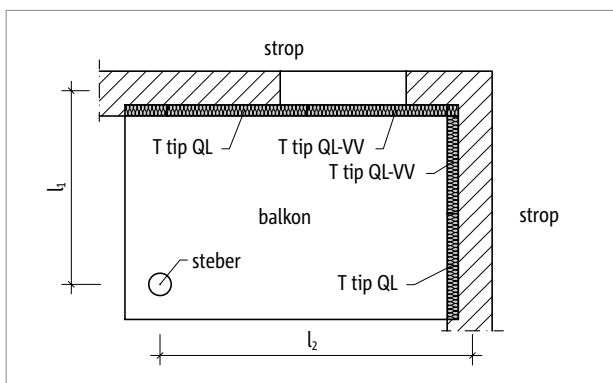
Schöck Isokorb® T tip QL: balkon z ležajem na stebrih
